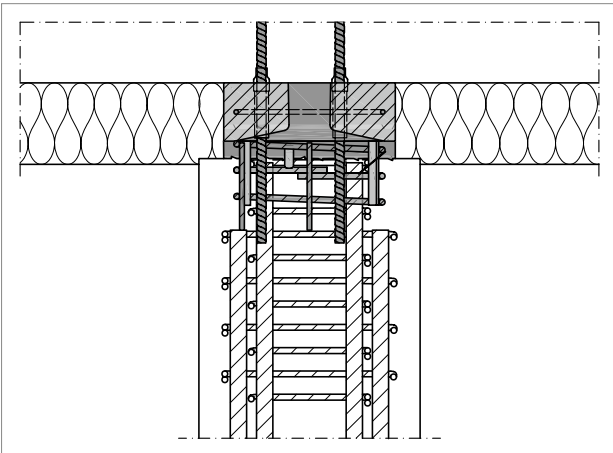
Schöck Sconnex® type P: Wapening in zone 1 - lengteprofiel van de kolom
